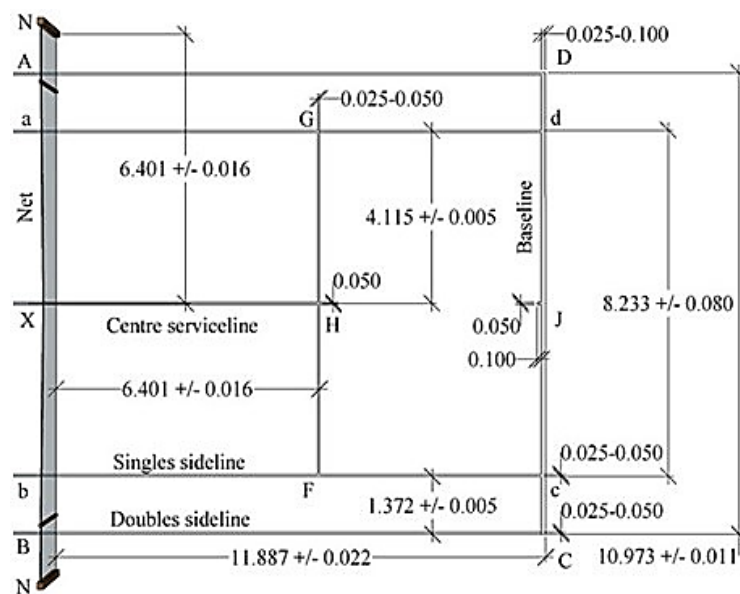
Plano de vista de la mitad de la cancha (las medidas están en metros). [3]
